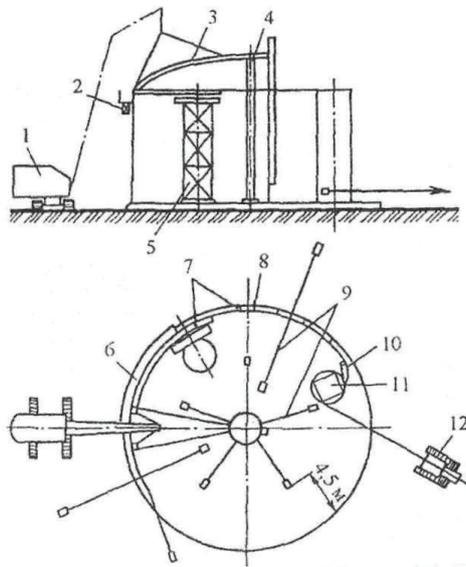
Одновременное разворачивание рулона корпуса резервуара и монтаж покрытия:
